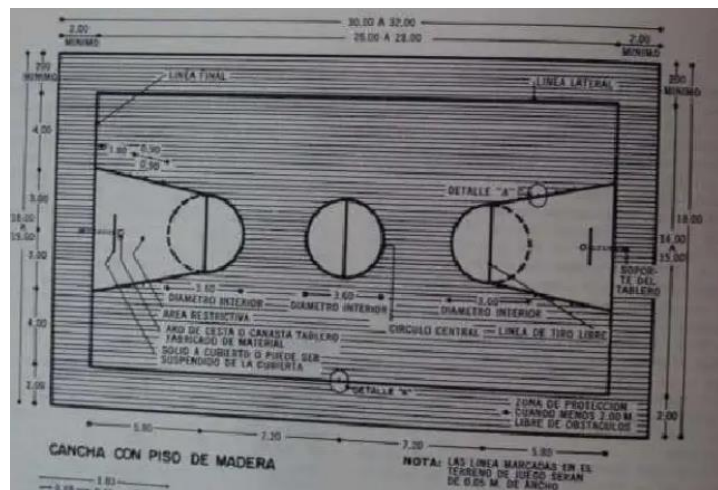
Vista de la cancha deportiva - con techo cubierto.
